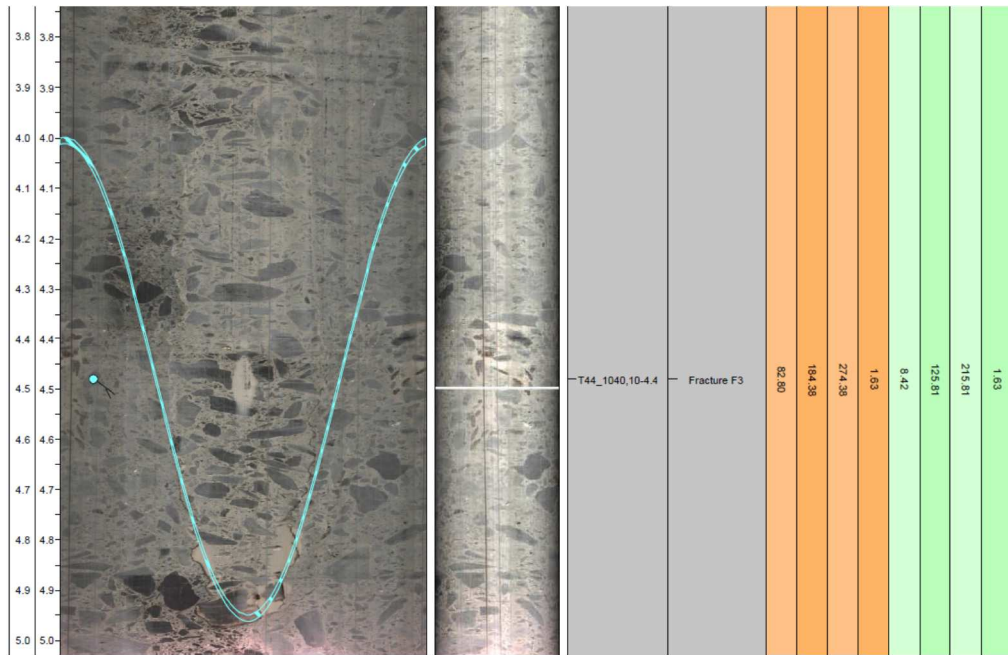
forage T44-1040,10 (plot 5/6) fissure inclinée à 8,4° par rapport à l'horizontale, située à 4,4 m du parement aval (ouverture 1,63 mm)
